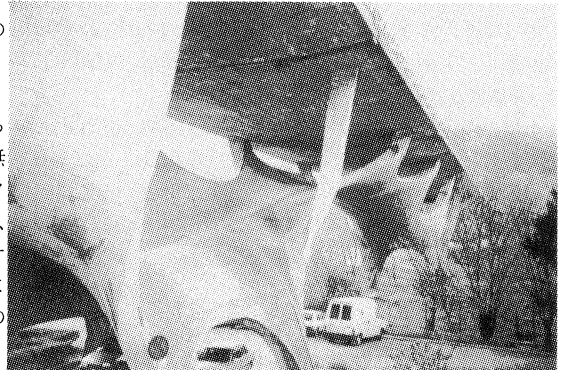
コンクリートらしさを表現した橋梁 (Basento River Bridge)
